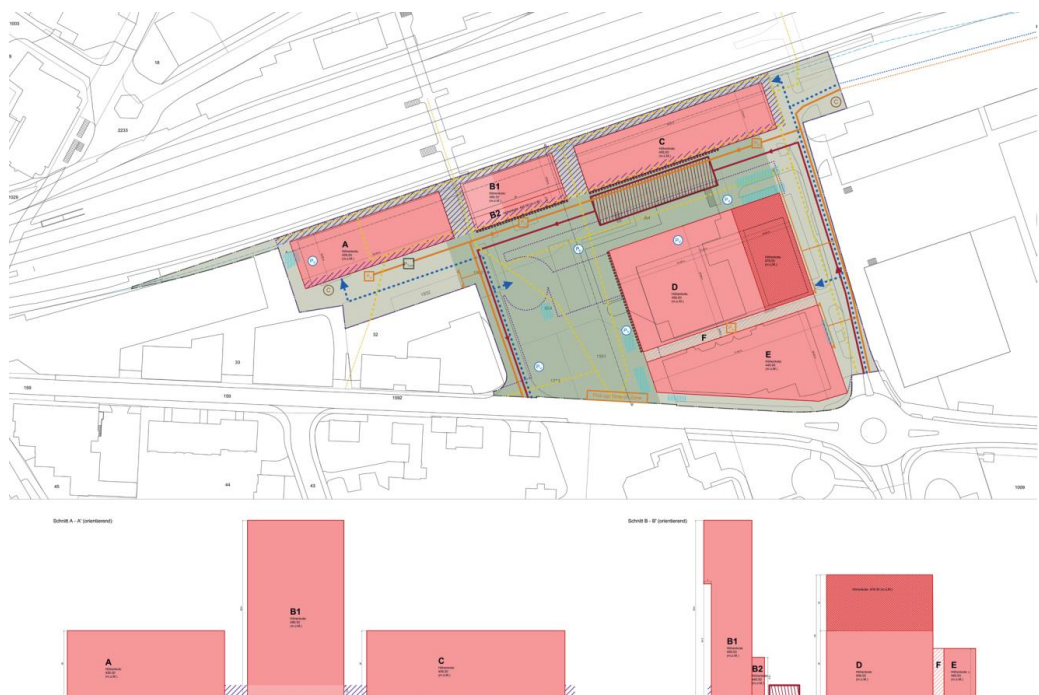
Grundriss und Schnitt BBP Dorfmann & Bahnhof Süd
